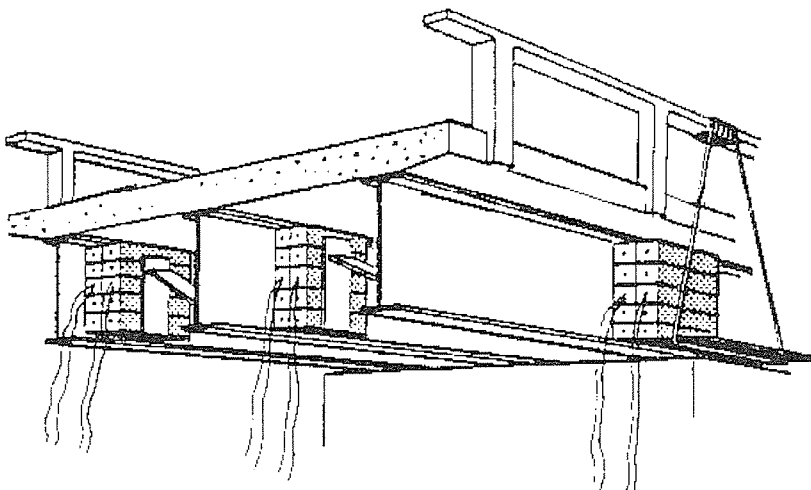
Destrucción de estructuras de vigas metálicas
